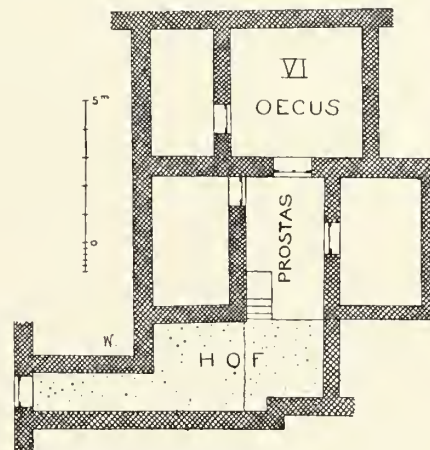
Grundriss des Hauses Nr. VI.
